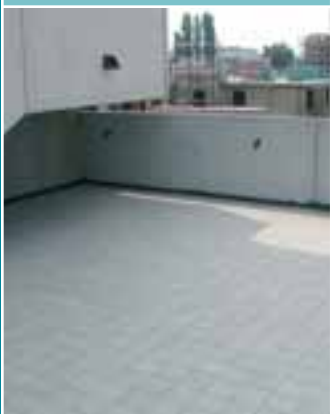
Выравнивание гидроизоляционного слоя ELASTOCEM MONO.
